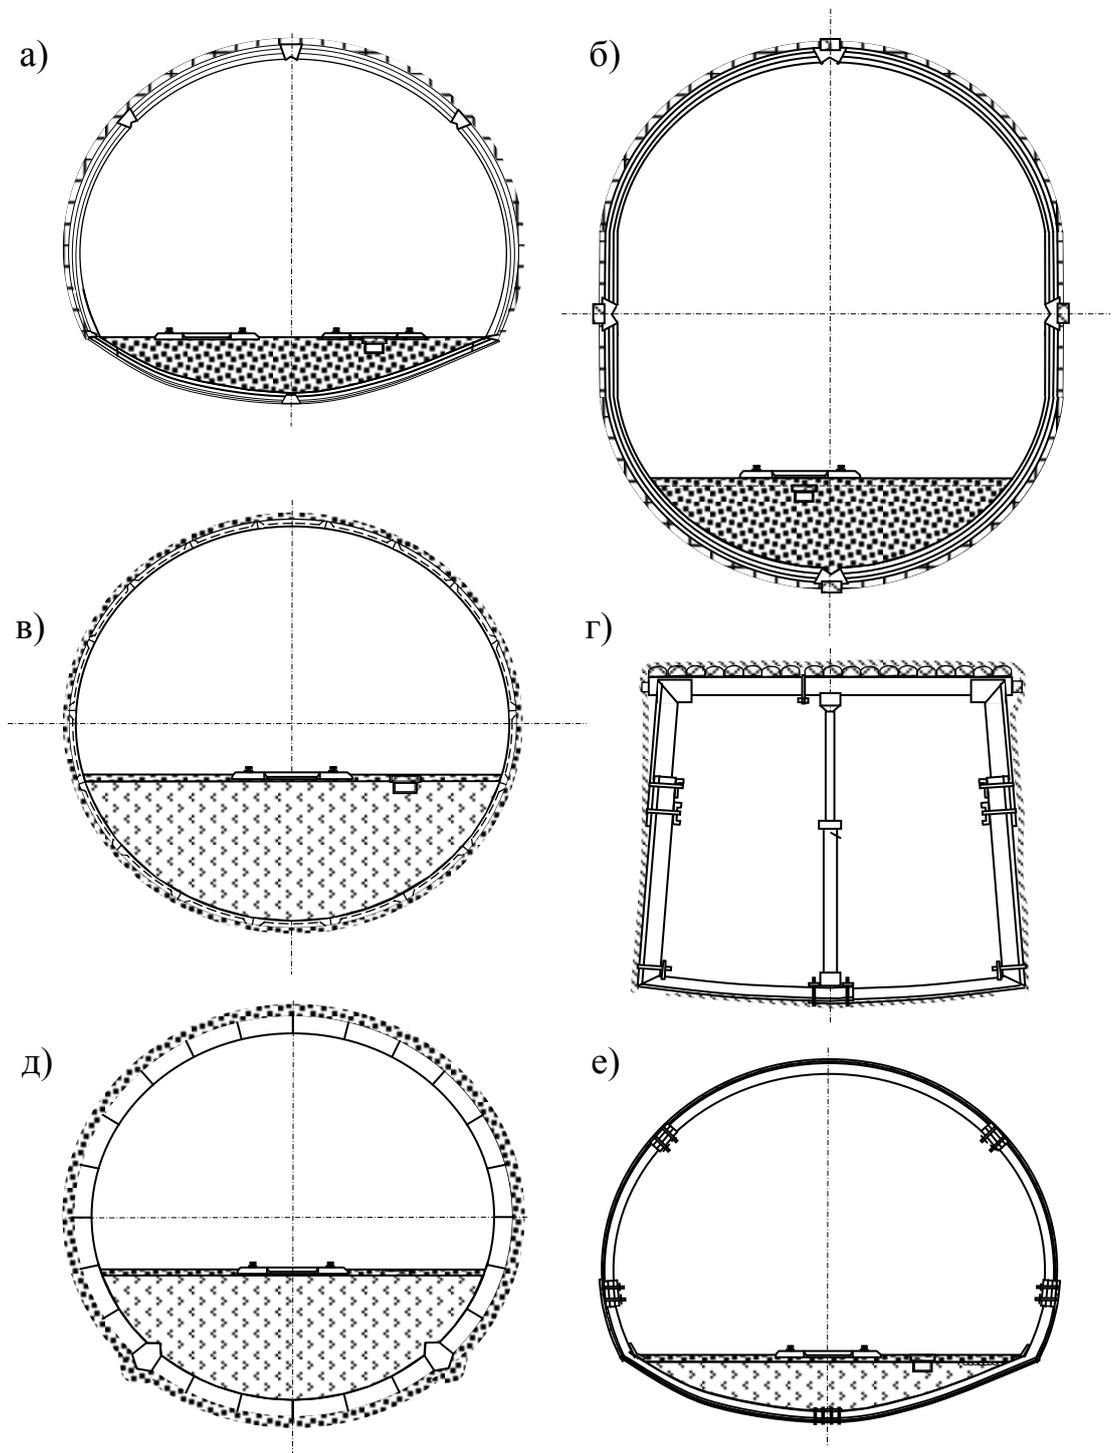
Замкнутые конструкции крепи: а - шарнирная арочная железобетонная крепь; б - шарнирная эллиптическая железобетонная крепь; в- гладкостенная тубинговая железобетонная крепь; г - металлическая трапециевидная податливая крепь с лежнем; д - блочная кольцевая бетонная крепь; е - металлическая податливая арочная крепь с обратным сводом.
